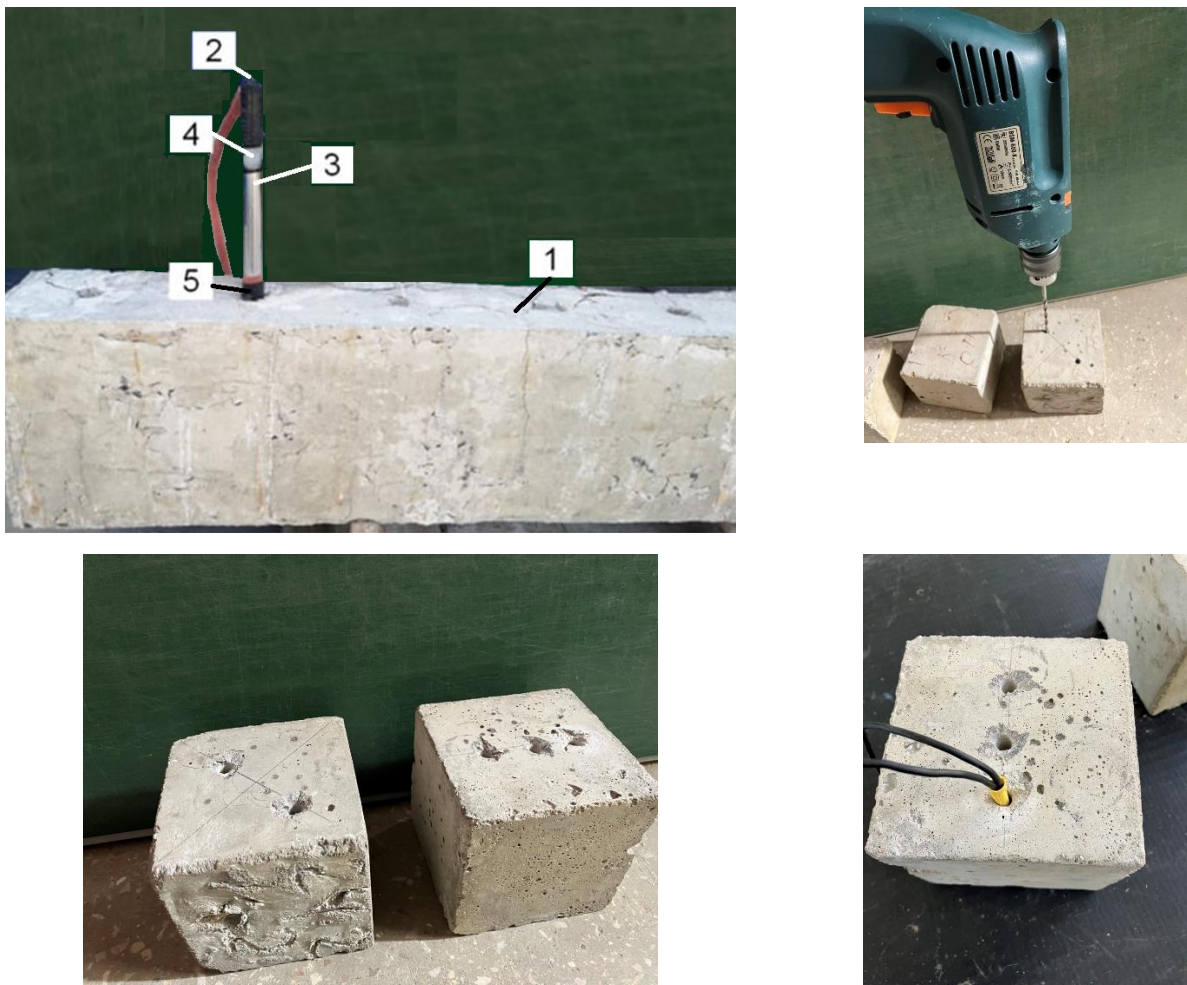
Підготовлені для руйнування зразки бетону
